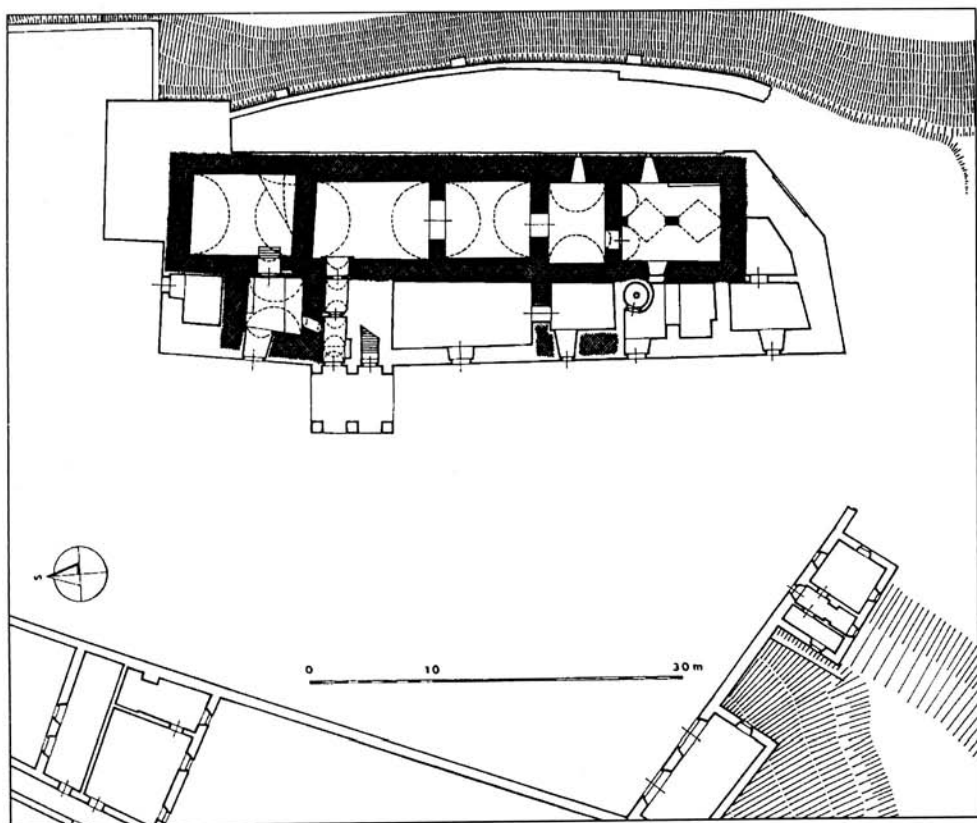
Grundriß der Burg Fulnek/Fulneck. Älteste Bauphase schraffiert.
